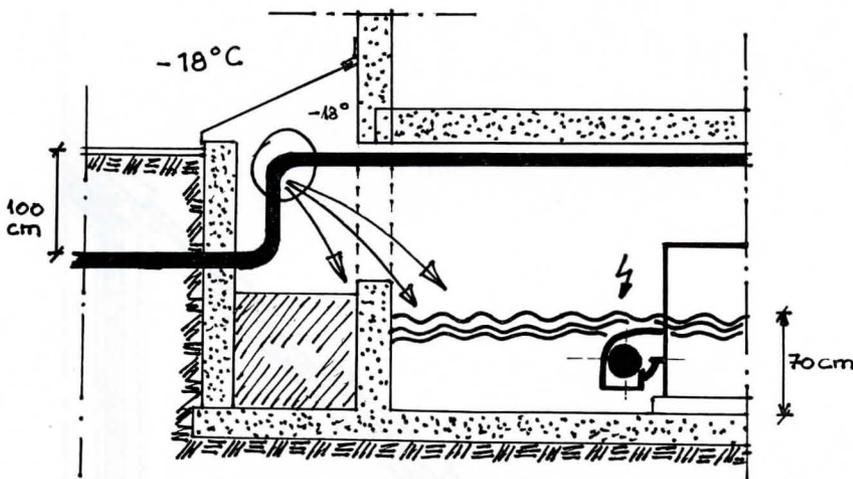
Der Bruch einer nicht isolierten nassen Löschwasserleitung setzte Heizungsanlage außer Betrieb und überflutete den Heizungsraum.
